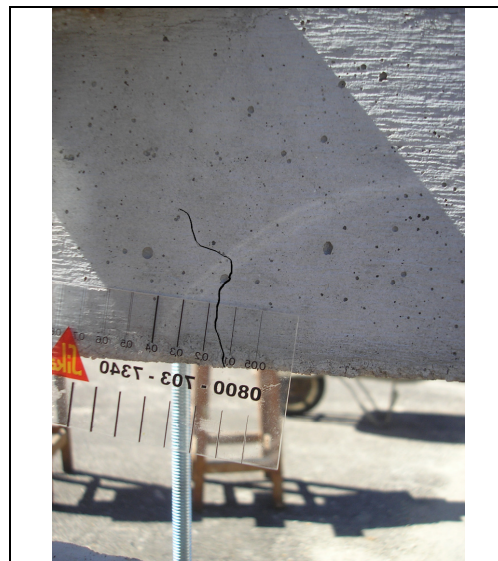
Medida da abertura de fissura no corpo-de-prova prismático com fissurômetro.
